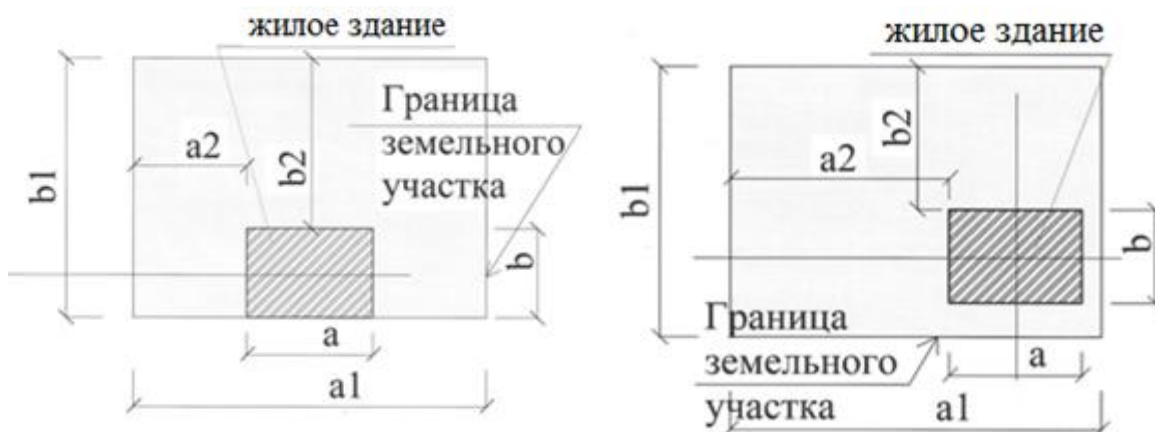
Схемы земельных участков со зданиями – прямоугольная или квадратная форма земельного участка, для зданий высотой 5 – 8 и 9 - 25 этажей со сторонами параллельными границам земельного участка
